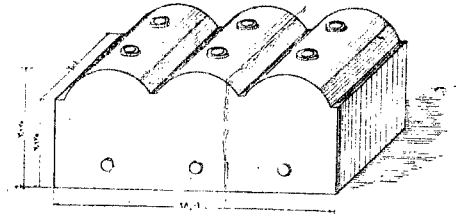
مسقط أفقي وقطاع رأسي في مجموعة صوامع
